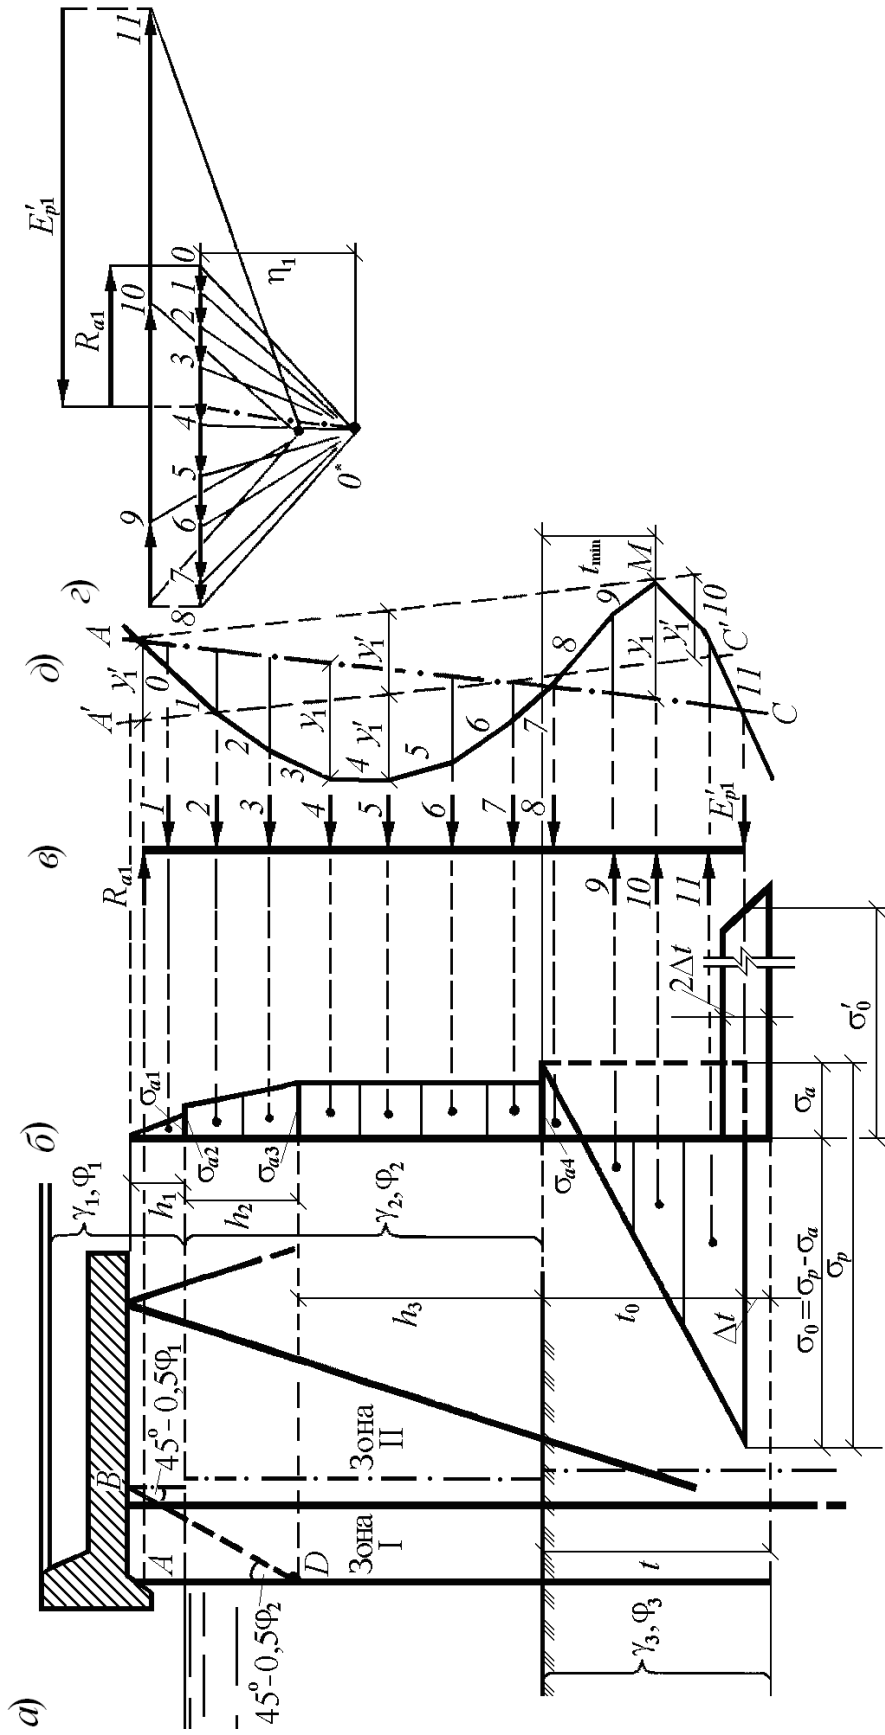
Графический расчет передней шпунтовой стенки на нагрузку от давления грунта, находящегося между шпунтовой стенкой и ближайшей экранирующей плоскостью (зона грунта I)
